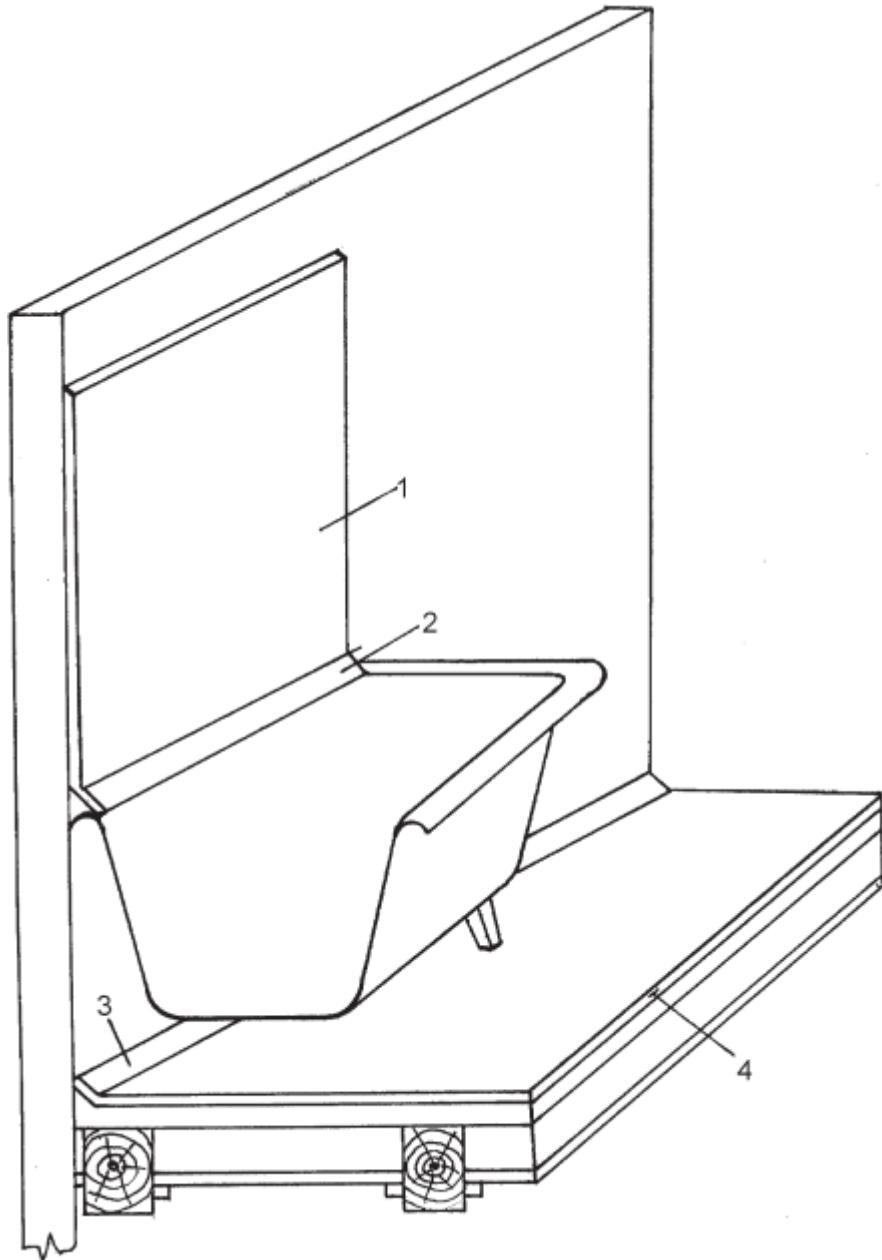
Установка ванны на деревянном полу: 1 – облицовка стены; 2 – заделка вдоль края ванны; 3 – заделка пола у стены; 4 – покрытие пола (позиции с 1 по 4 в водоупорном исполнении)
